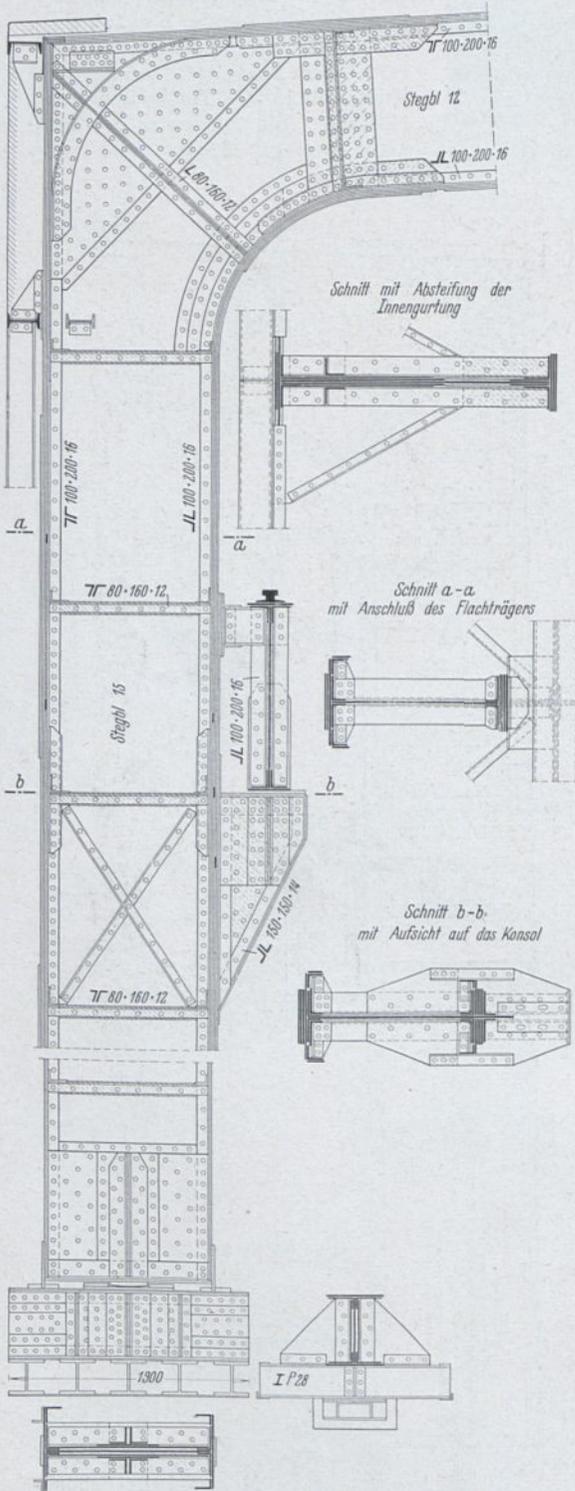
Montagehalle Schönevide. Ausbildung der Regelbinder.
